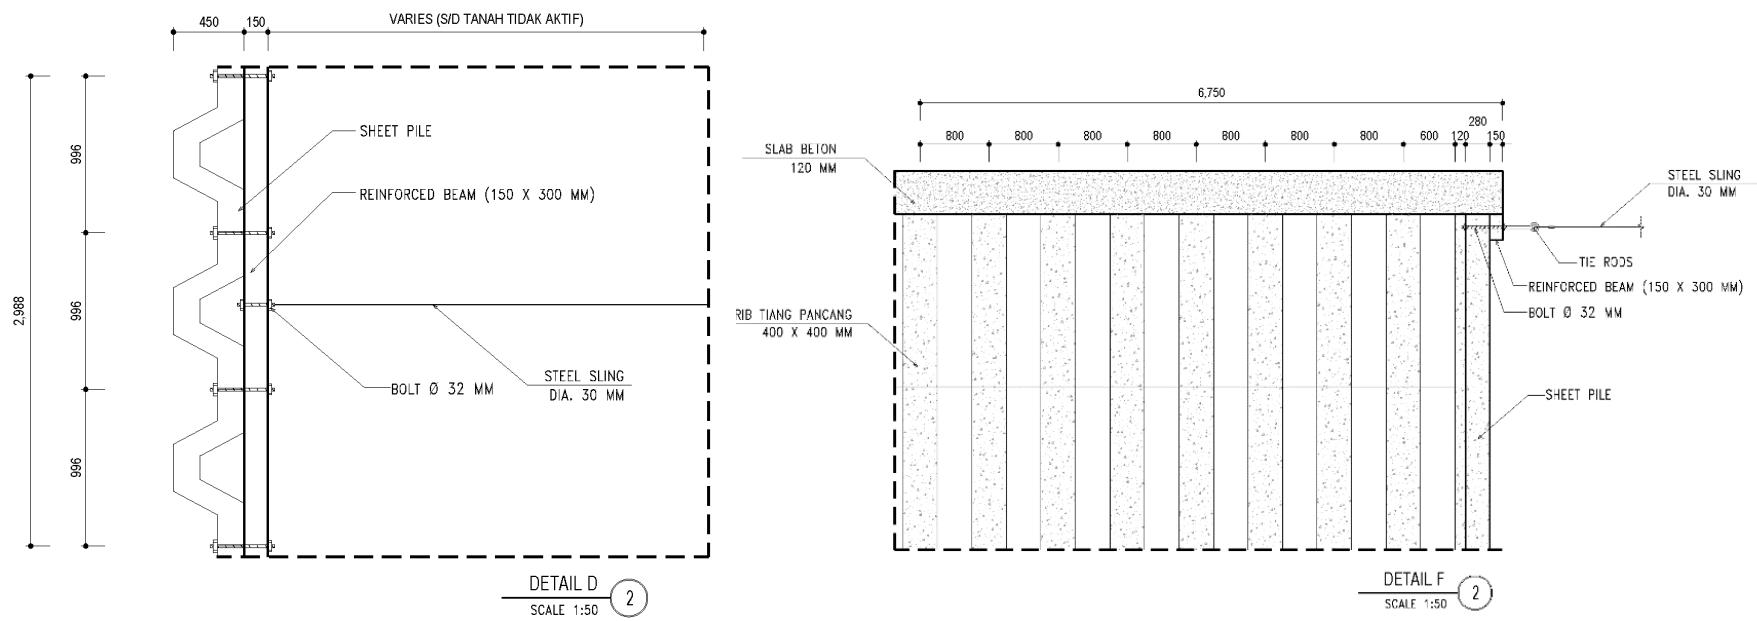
Layout Parsial Alternatif 1 *Sheetpile
